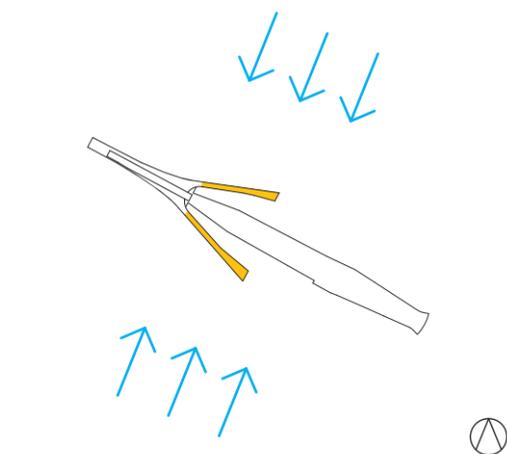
Piktogramm Windschutz der Holmenkollen-Schanze o. M. (Grundriss)
